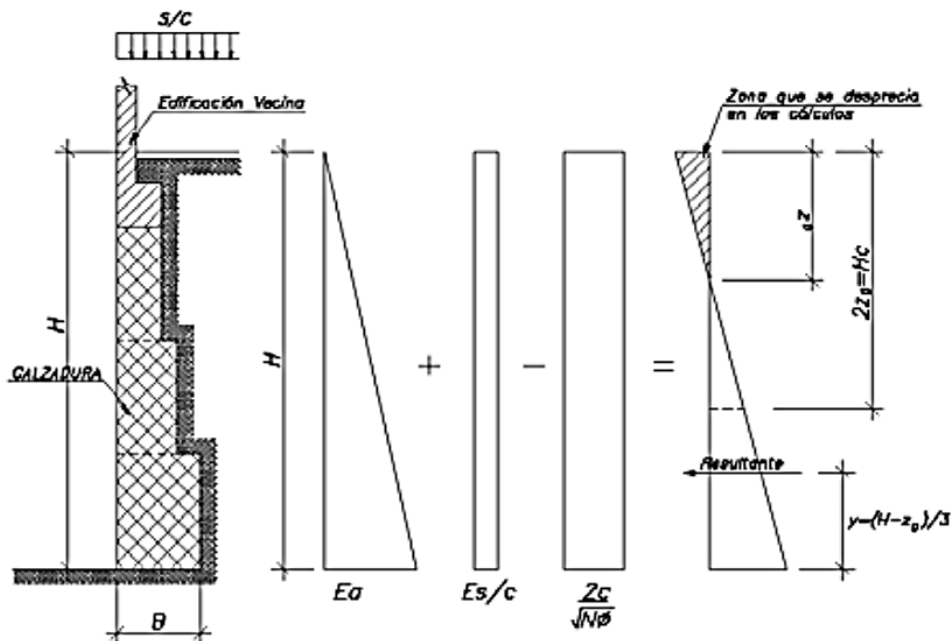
Cargas que actúan sobre las calzaduras (Blanco, 2008).
